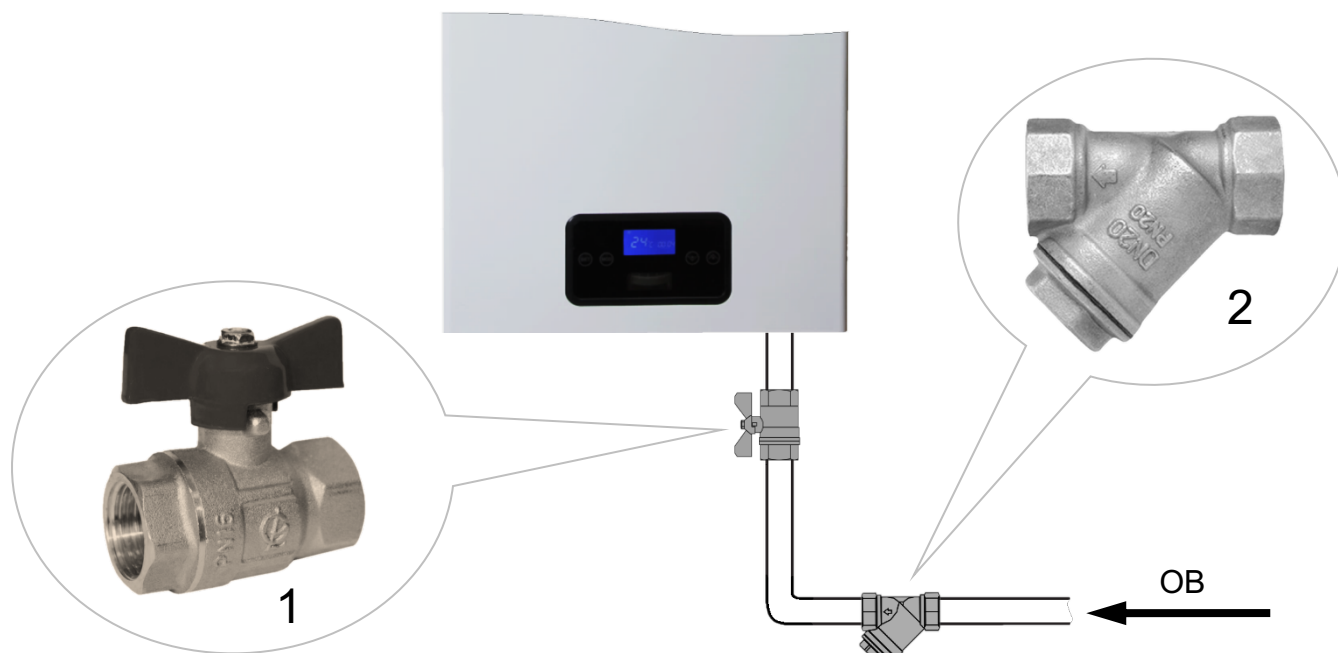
Монтаж труб системы отопления и водоснабжения.
